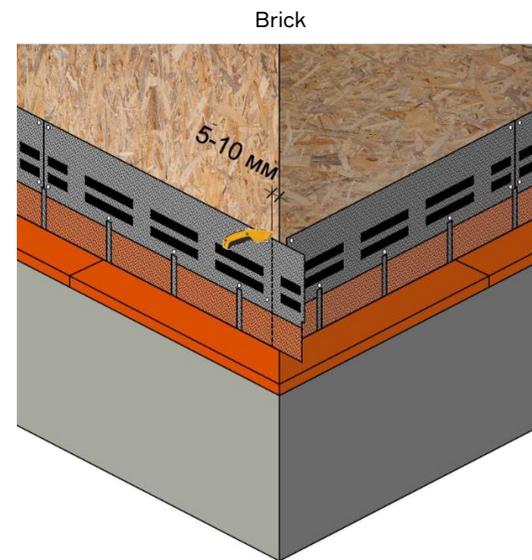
Подрезка фасадной плитки при подходе к углам.
